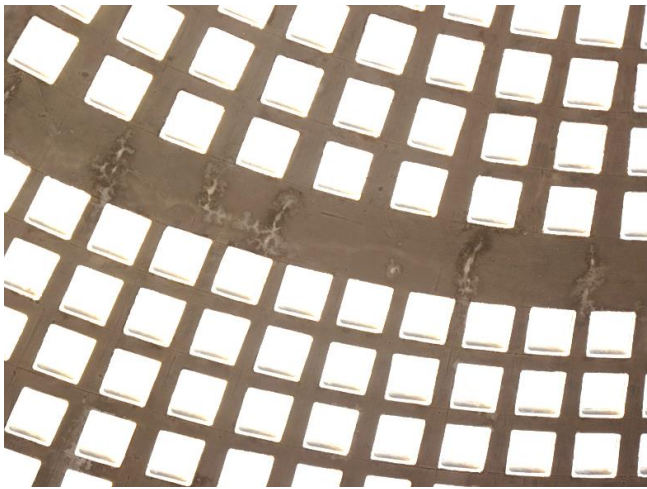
Voile blanchâtre et concrétions salines sur la poutre circulaire au droit des armatures radiales
